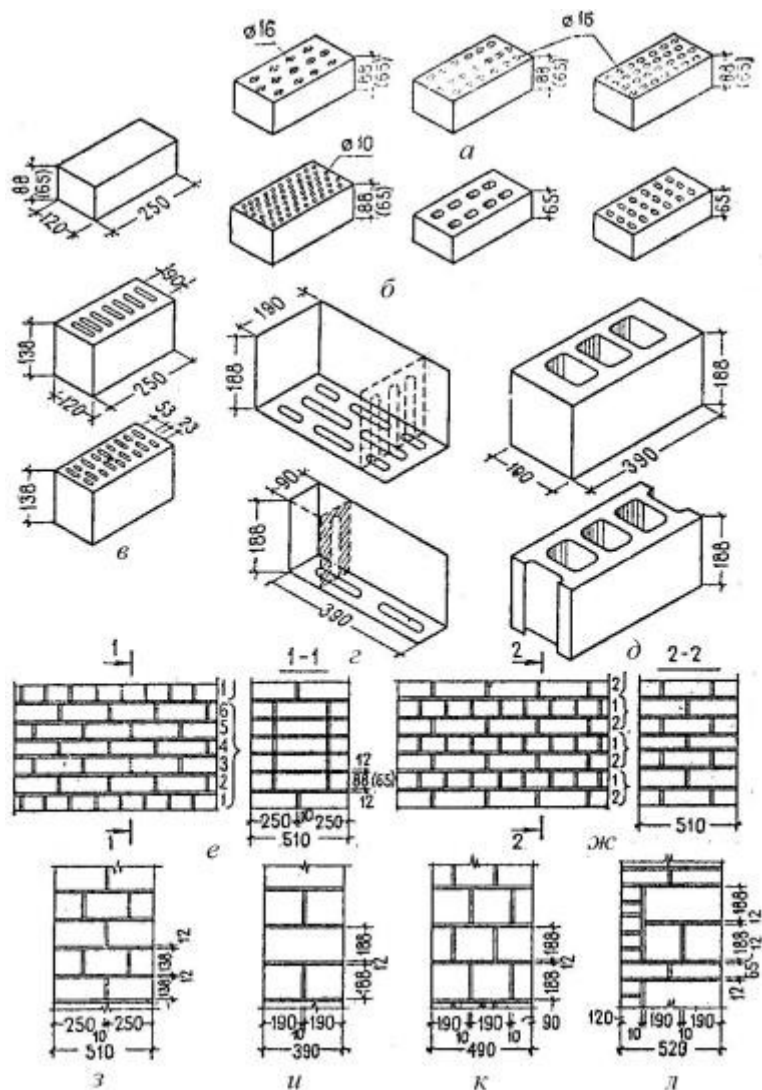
Материалы и типы сплошных кладок наружных каменных стен.
